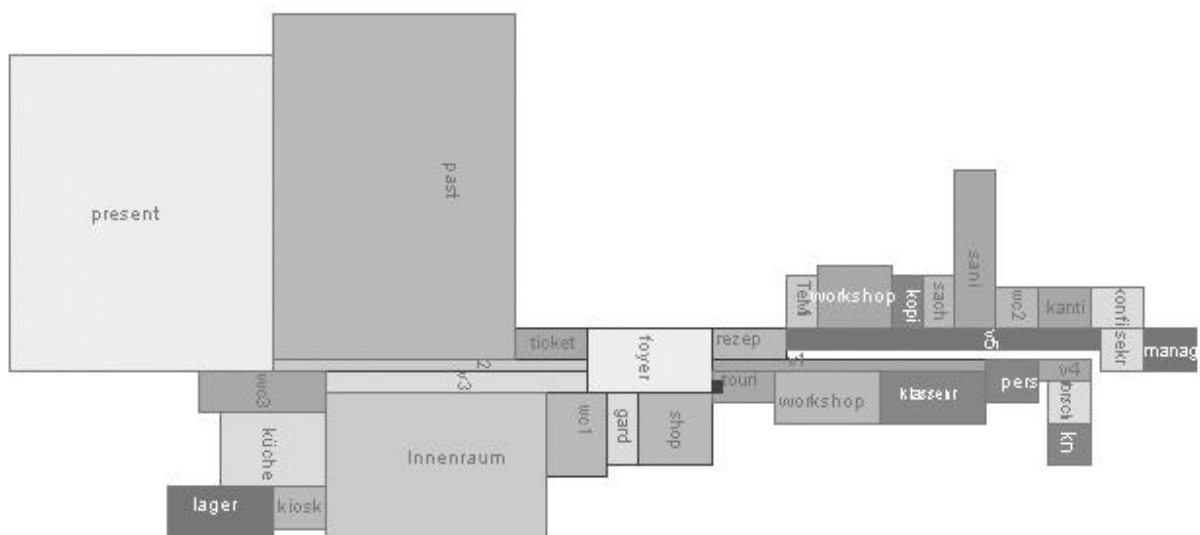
Beispiel für einen zulässigen Grundriss
